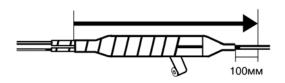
Обмотка корпуса разветвительной муфты лентой ВМ.
